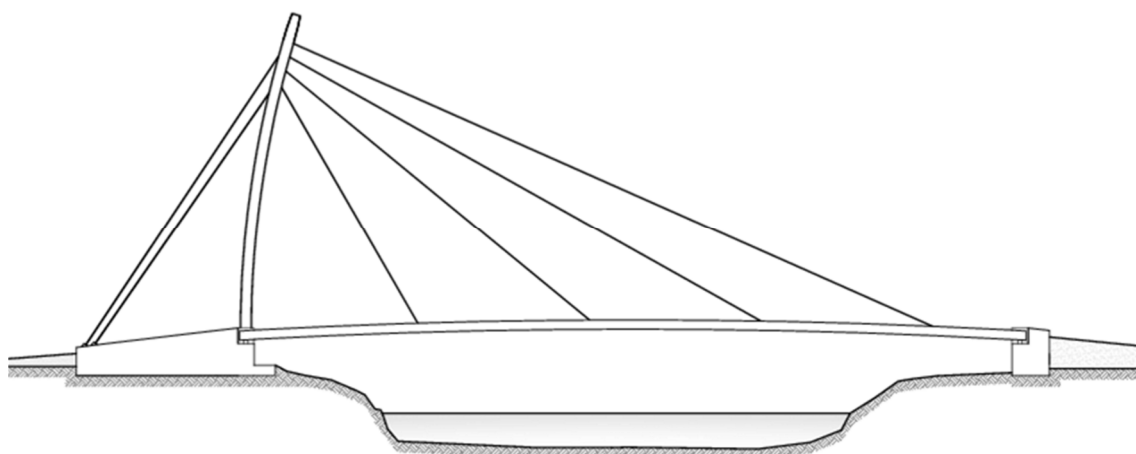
Soluzione 1 - Sezione longitudinale
